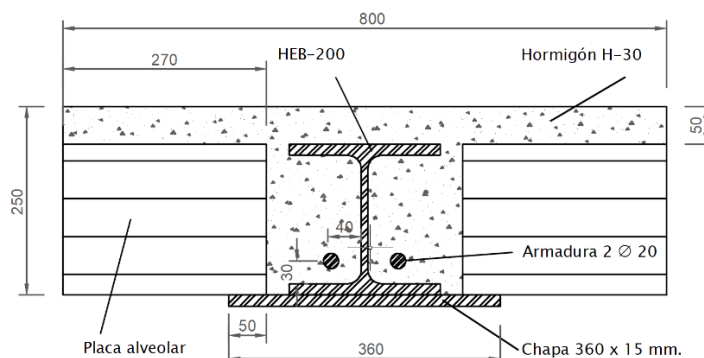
Esquema de slim-floor patrón. (cotas en mm)
